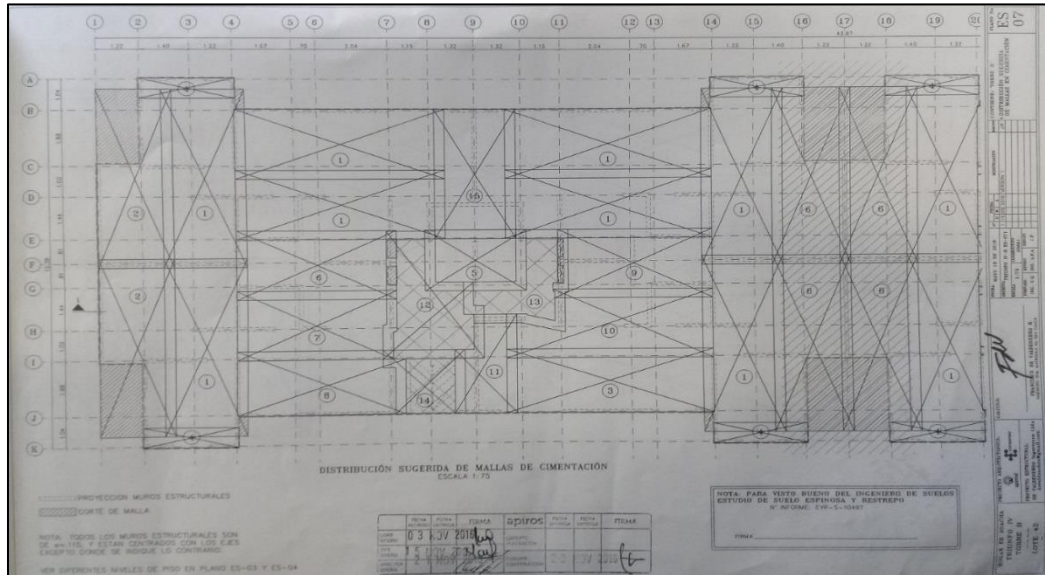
Y 61 PLANO ESTRUCTURAL ES07 – ES 08 DE DISTRIBUCIÓN DE MALLAS PARA PLACA DE CONTRA PISO
